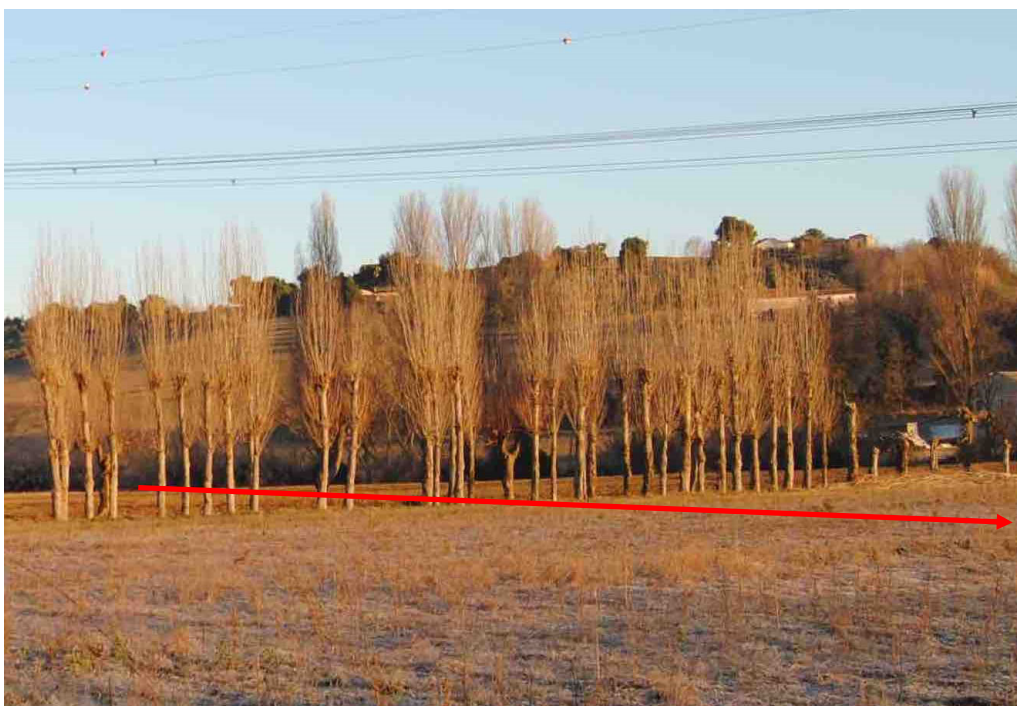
Filare attraversato dalla linea in progetto presso il Km 141+918
